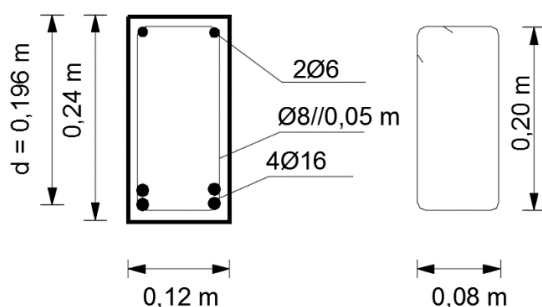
Corte transversal de viga-tipo – ensaio à flexão
